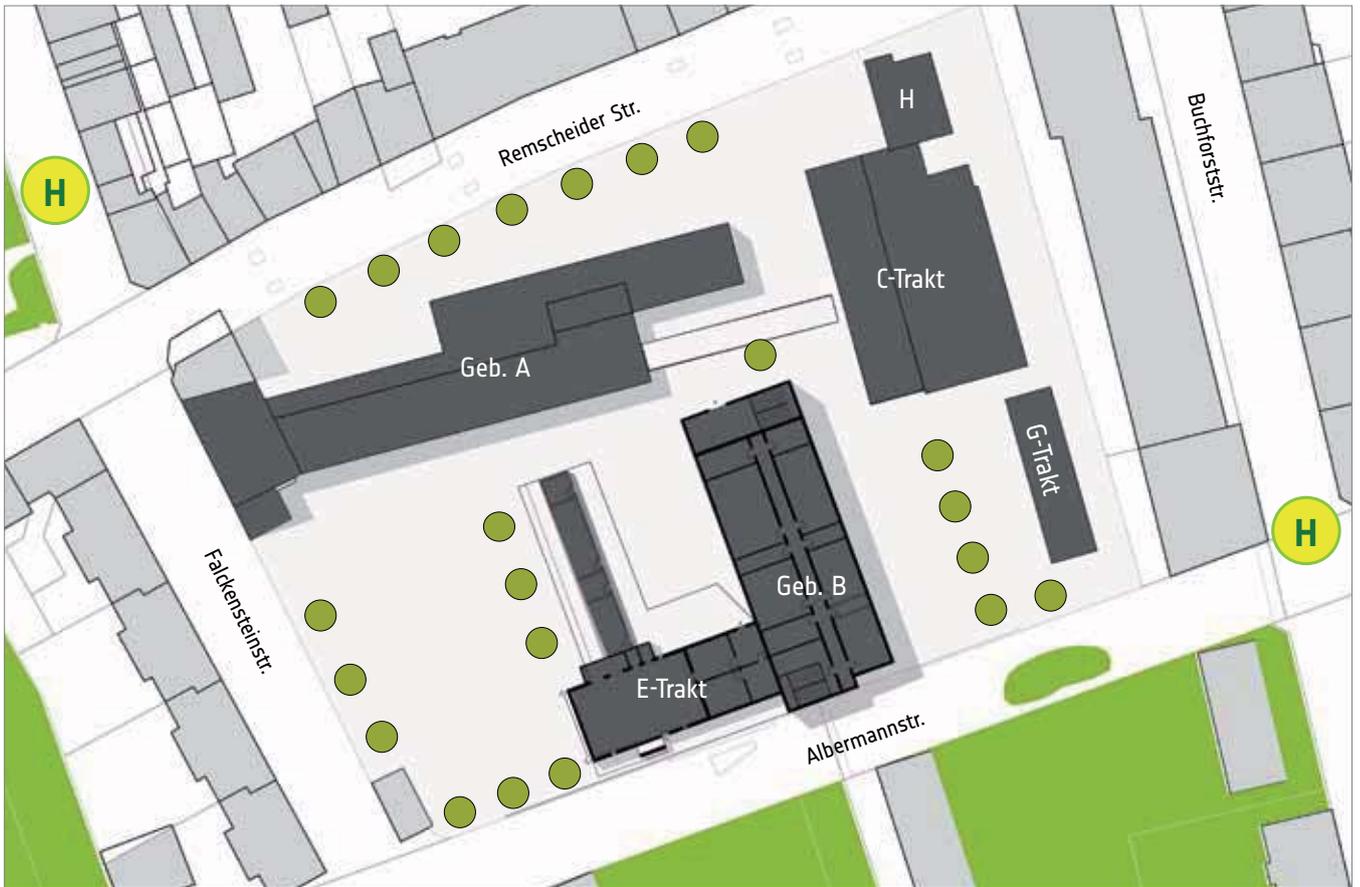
Lageplan und Bilder des Schulstandortes Albermannstraße / Falckensteinstraße
